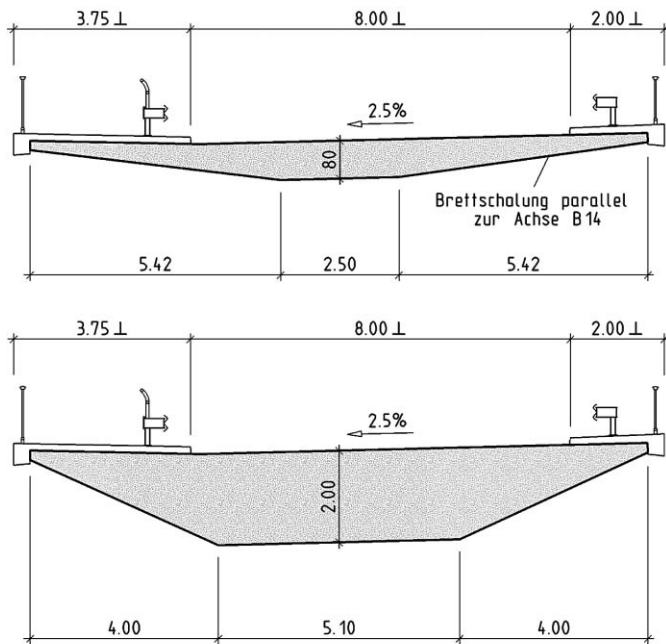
Bauwerk 5, Winnenden: Querschnitte B-B und C-C
